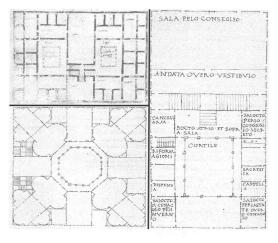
Modelos de escalera de caracol de planta cuadrada, en planta de habitación principesca. Tav. 208, fol. 24 v (inferior izquierda). Modelo de escalera en forma de T, en planta palaciega (superior izquierda) y del Palacio de la República (derecha). Tav. 32, fol. 18 v y Tav. 206, fol. 23 v (Giorgio Martini 1967)
